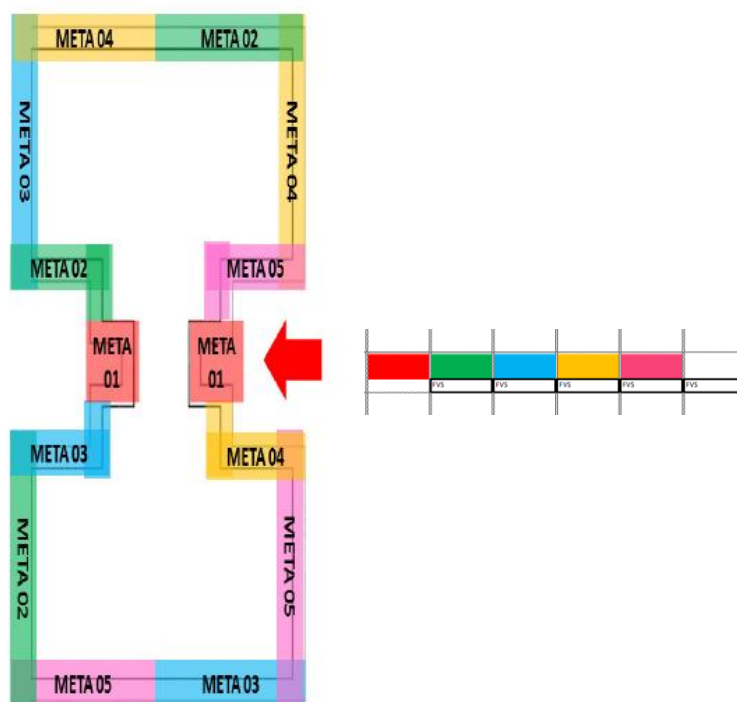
Proposta de sequência de execução do estuque de fachada. (Fonte: Construtora A)
